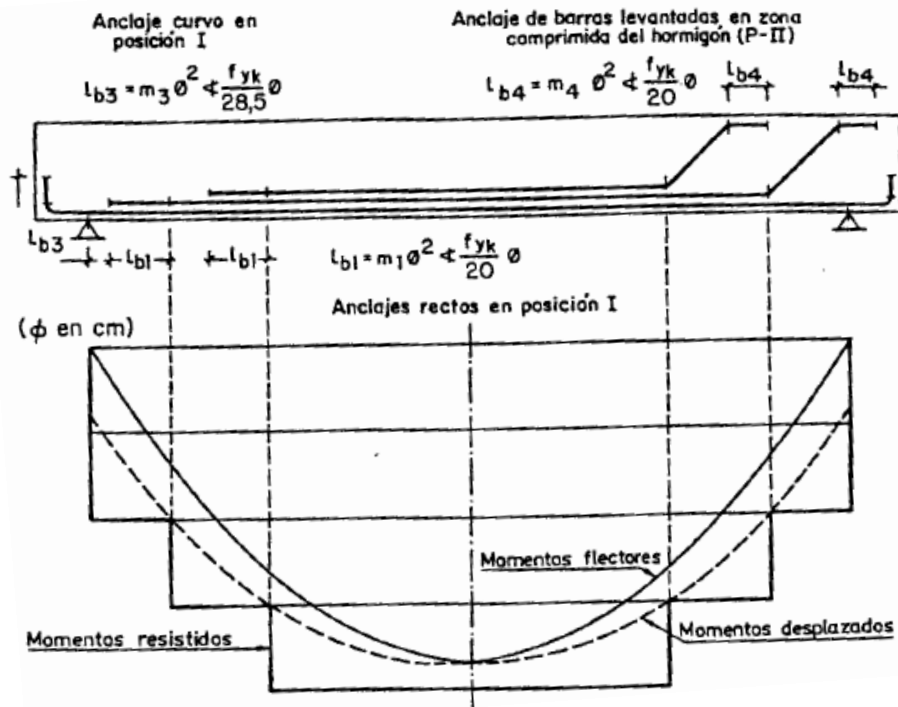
Ejemplo de anclaje de barras rectas sobre apoyo
